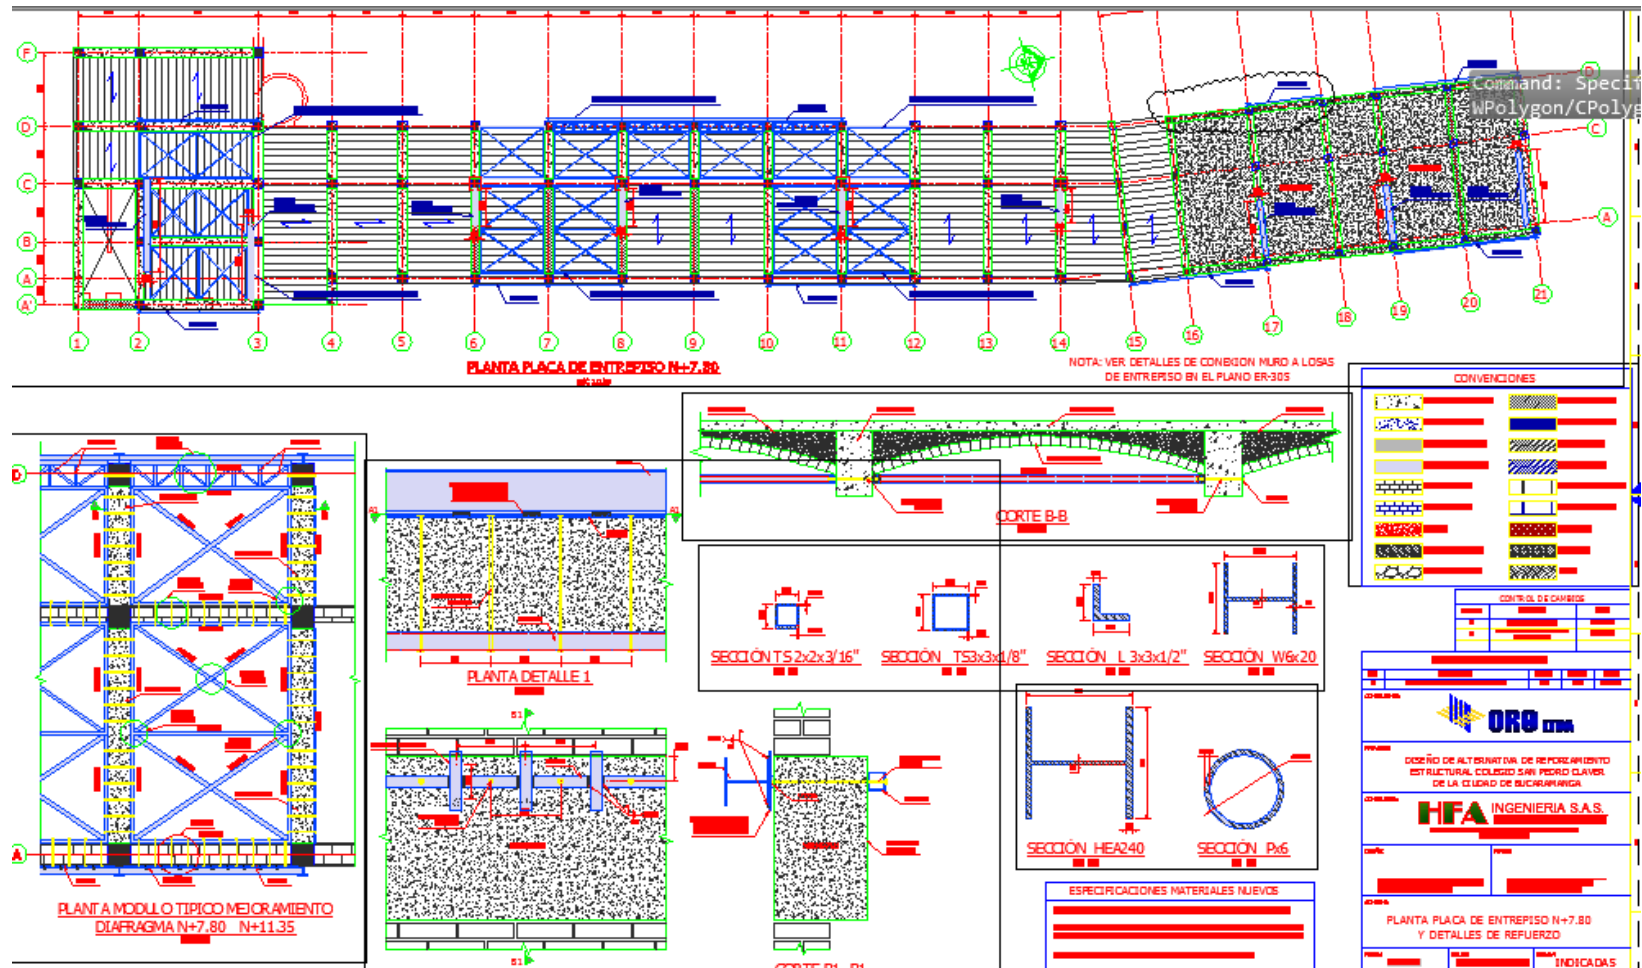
Planta Placa de entrepiso N+7.80 - 11.35 y detalle de refuerzo.
